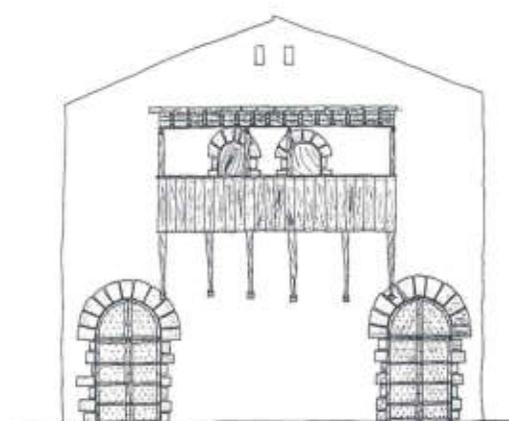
/ Ipotesi ricostruttiva del prospetto su via delle Caparecce.
